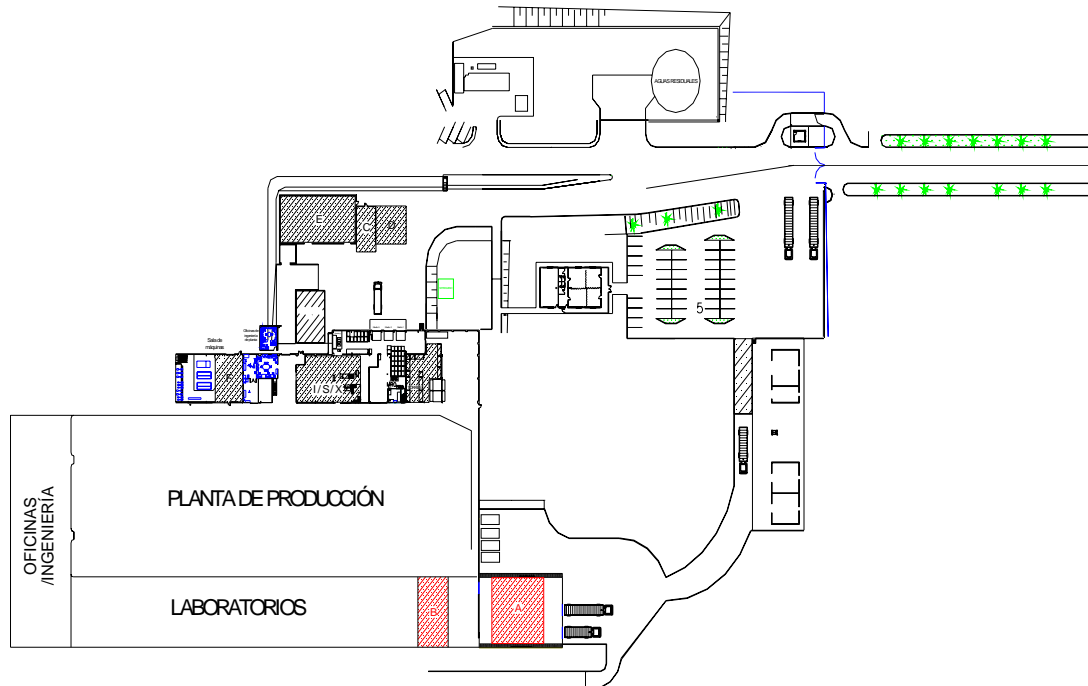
Plano general de la Planta en Visteon Cádiz.
